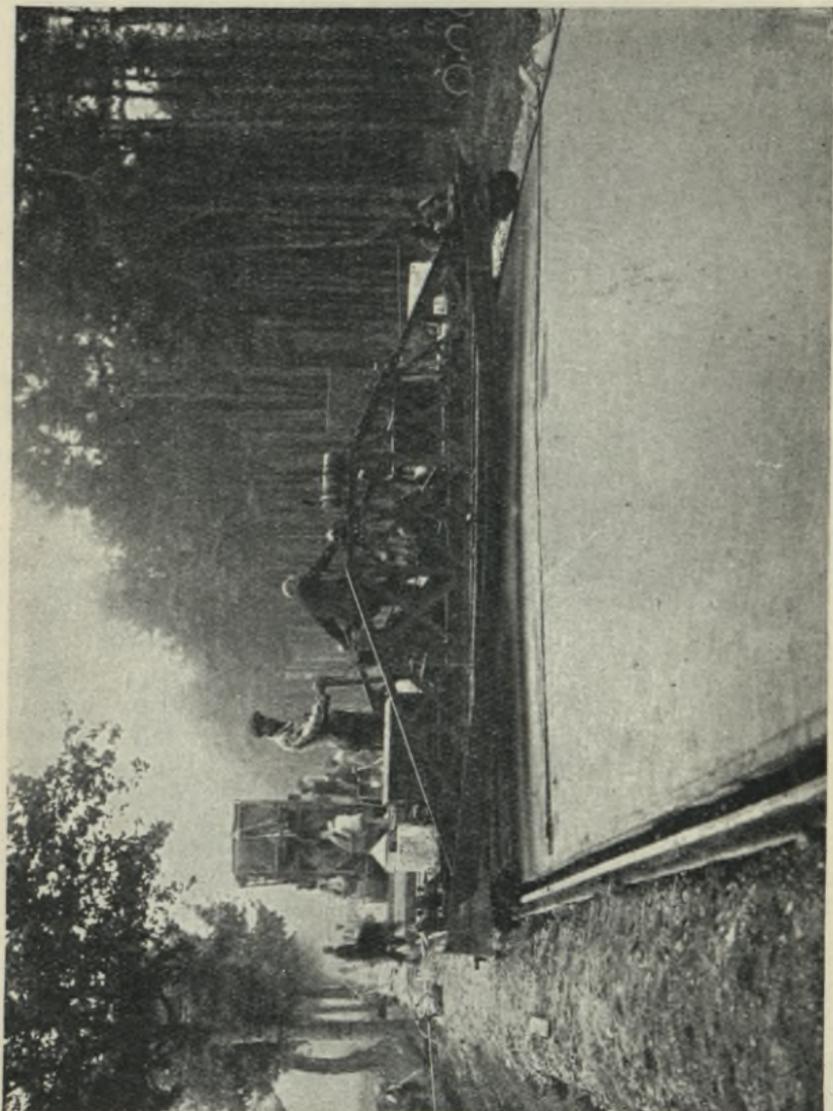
Betonstraße München-Ingolstadt bei Neuherberg. Straßenfertiger bei der Arbeit.
